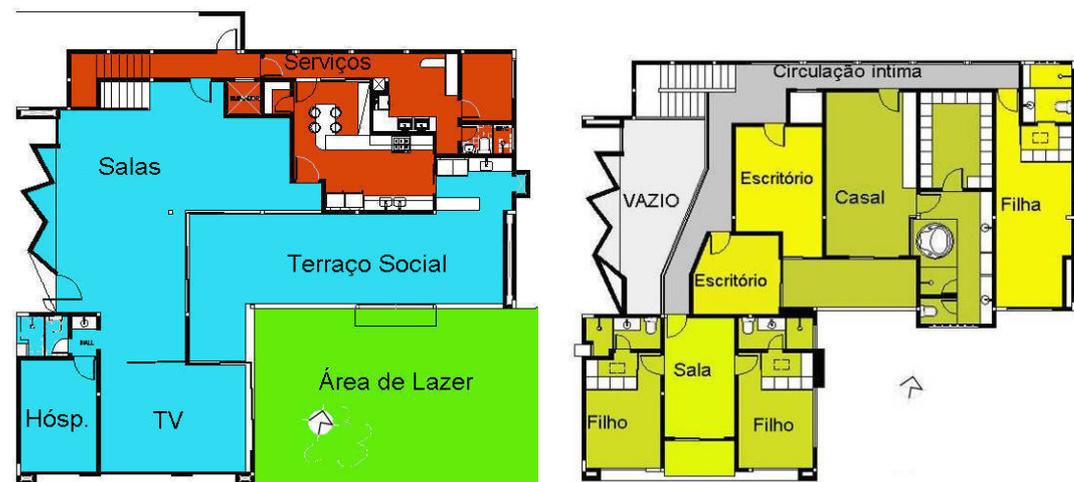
Plantas baixas dos pavimentos térreo e superior
